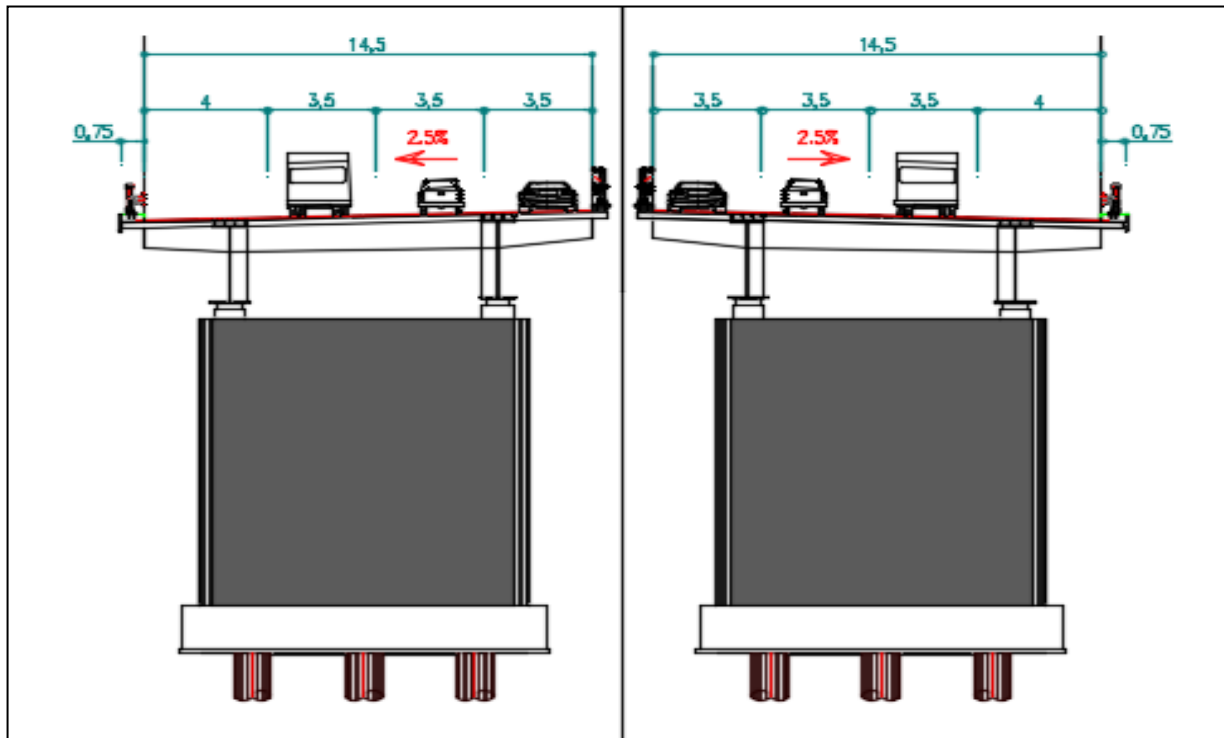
Coupe transversale Sur pile VARIANTE 03
